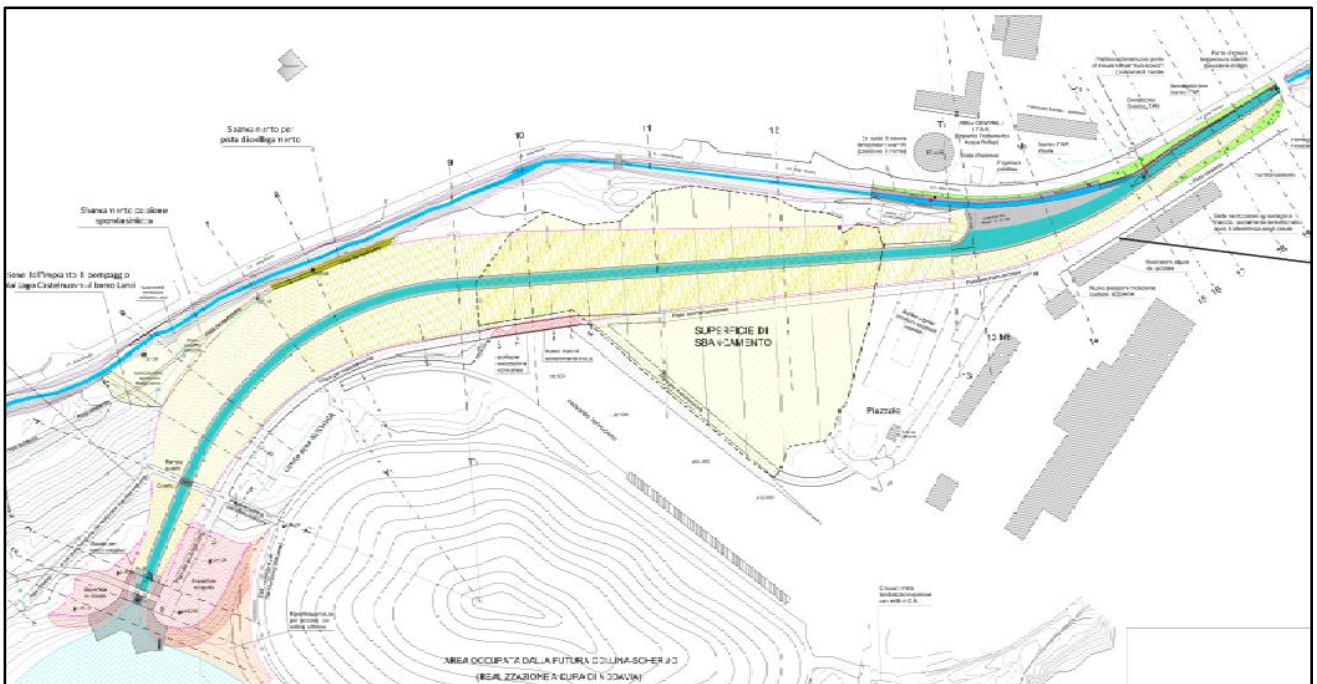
TAV. 3 - STATO DI PROGETTO: PLANIMETRIA
